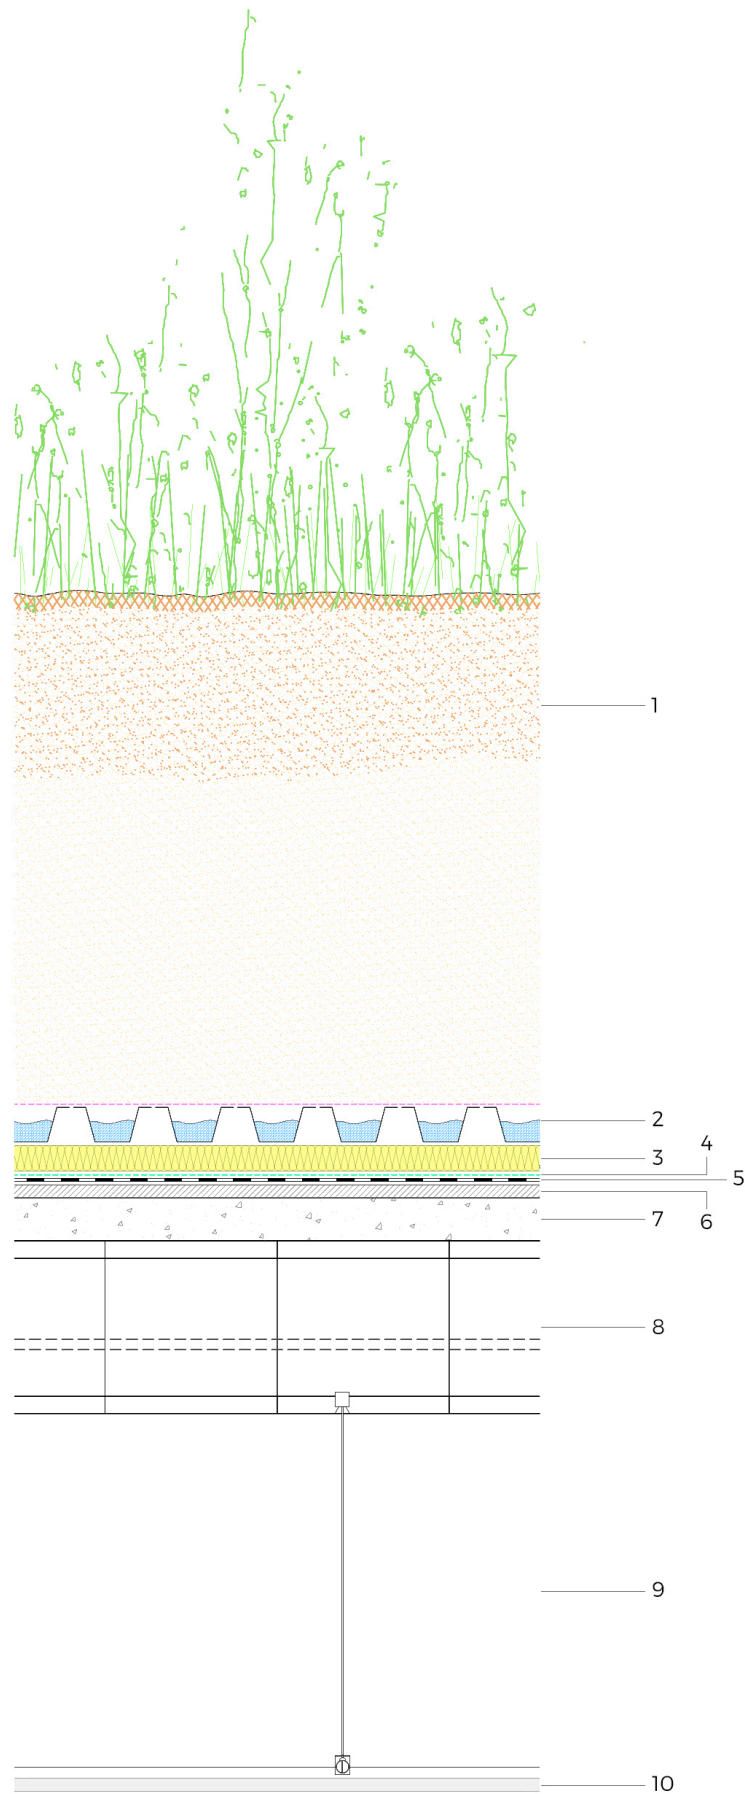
Detalle constructivo de cubierta del modelo C tras rehabilitación.
